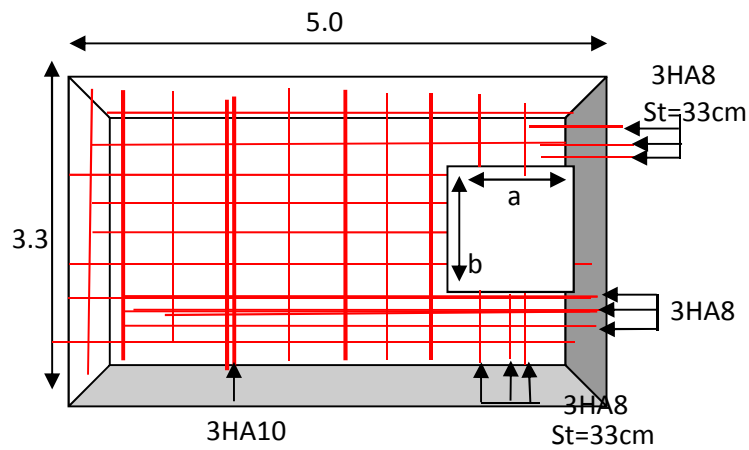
Schéma de ferrailage de la dalle sur 4 appuis.
